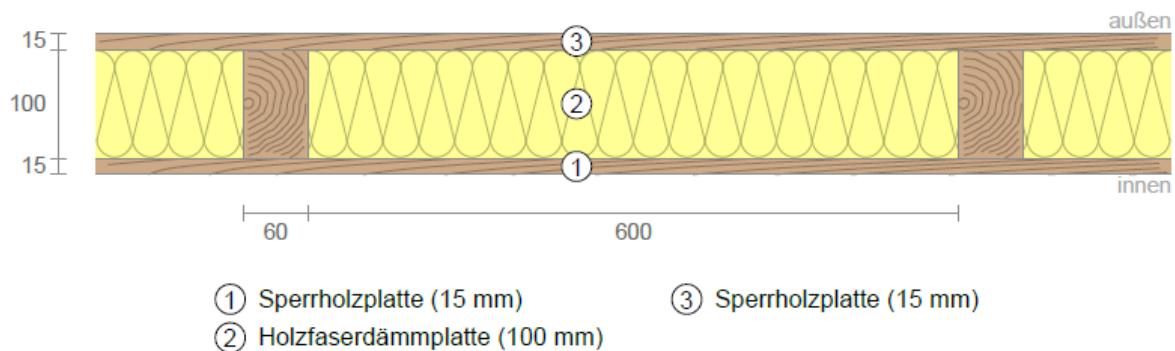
Aufbau Holzständerwand. Erstellt mit U-Wert.net
